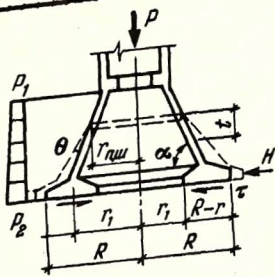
Расчетные схемы фундаментов-оболочек сооружений башенного типа
